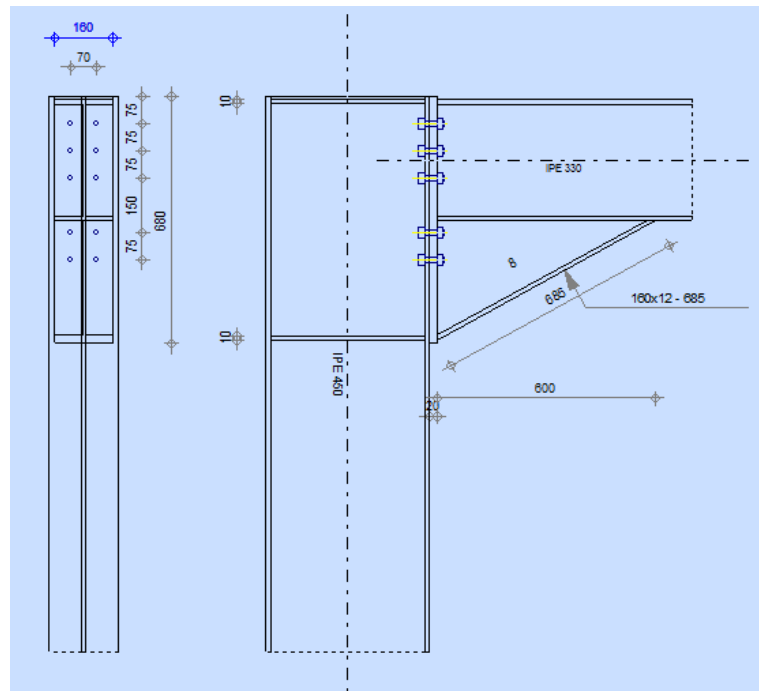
Schéma d'assemblage (poteau-poutre maitresse)
